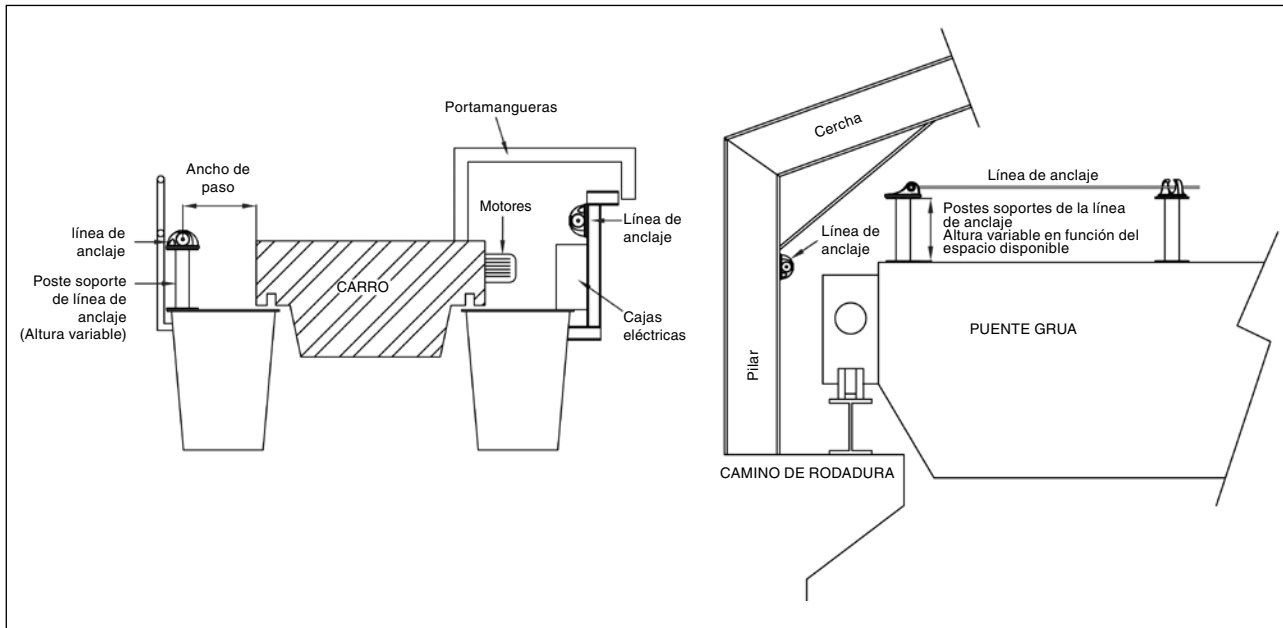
Esquemas de montaje de líneas de anclaje instaladas sobre un puente grúa
